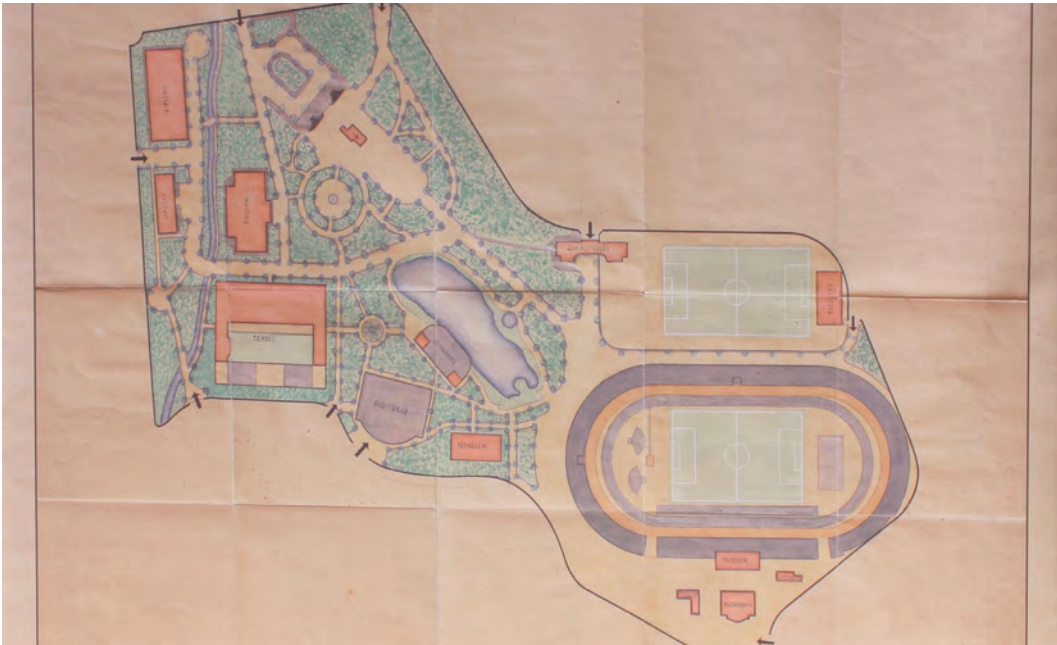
Planta do Parque da Ponte e do Estádio 1º maio
